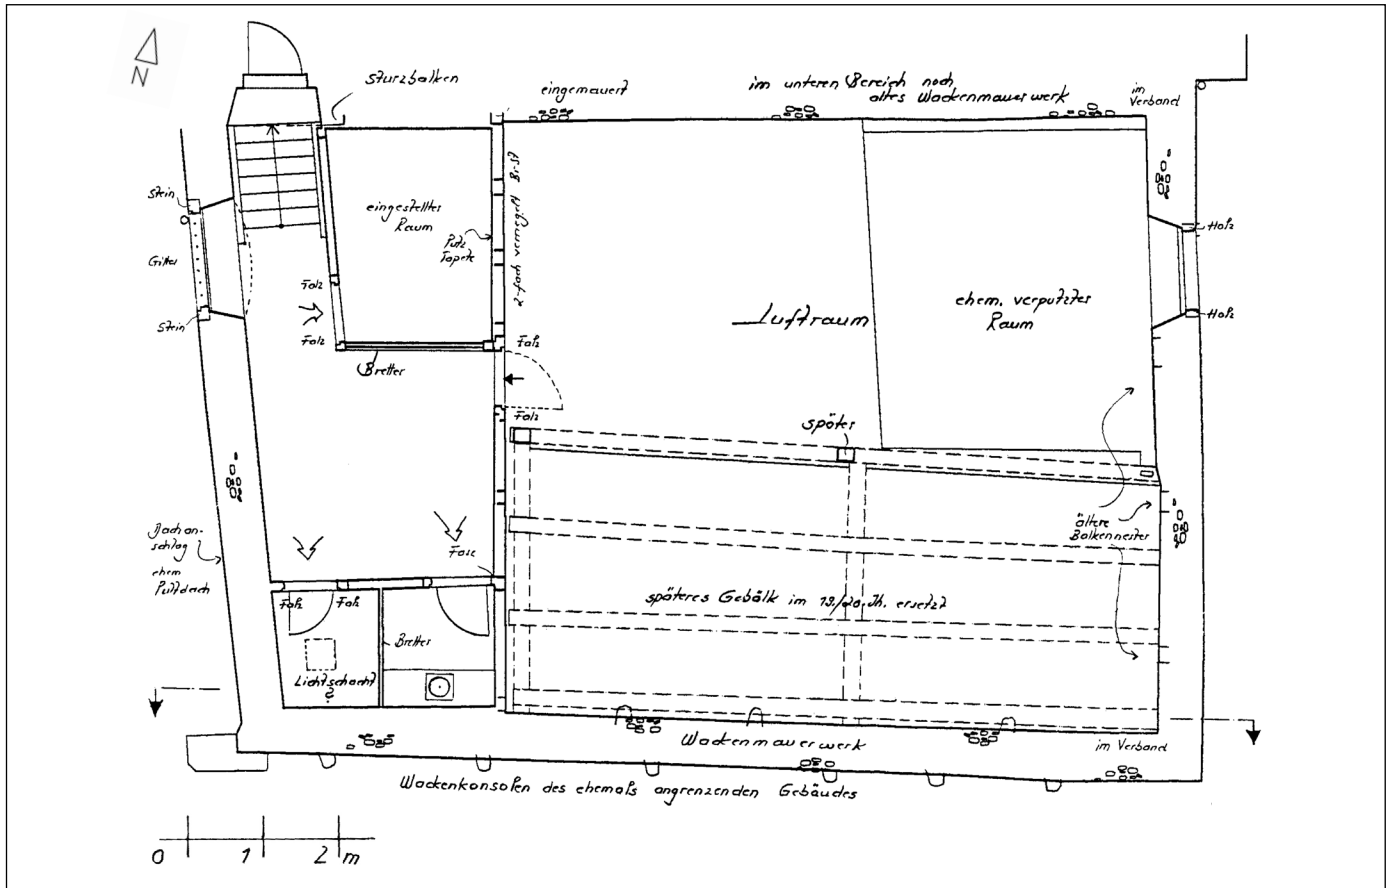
Kirchstraße 2, Scheune, Grundriss Obergeschoss.
